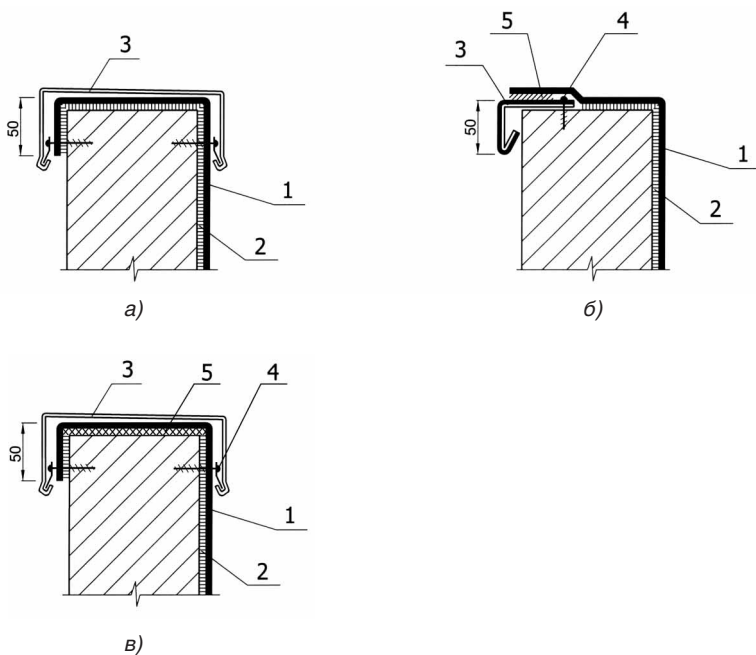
Примыкание кровли к парапету (бетон, пеноблок, кирпич):
